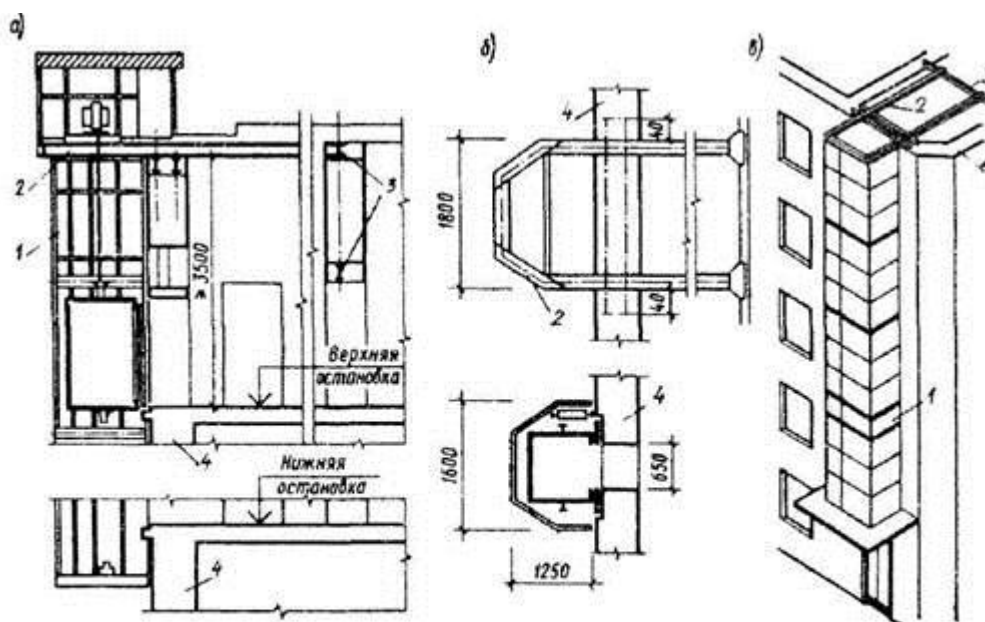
Конструкция наружного подвешного лифта:
